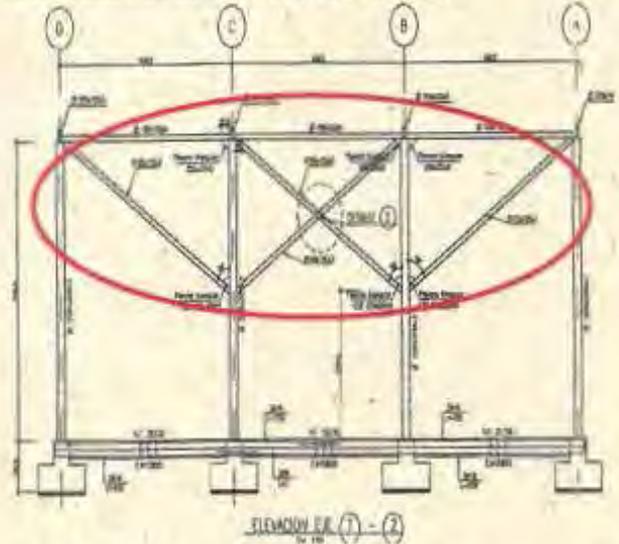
Plano N° STR-01, perfiles metálicos proyectados en forma diagonal, en la elevación eje 1 y 2.
